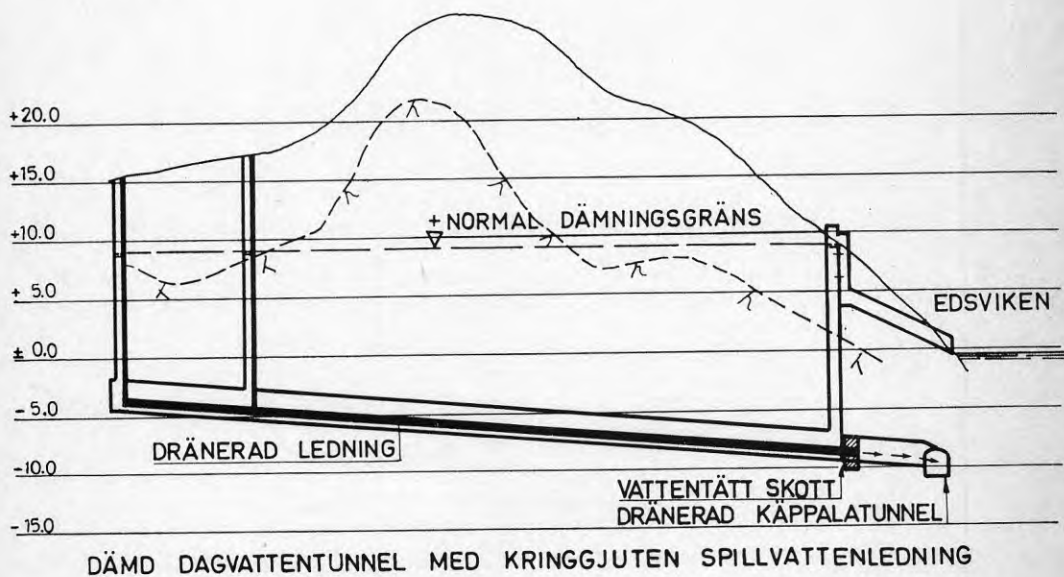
Sollentuna-centrum-tunneln. Typprofil
